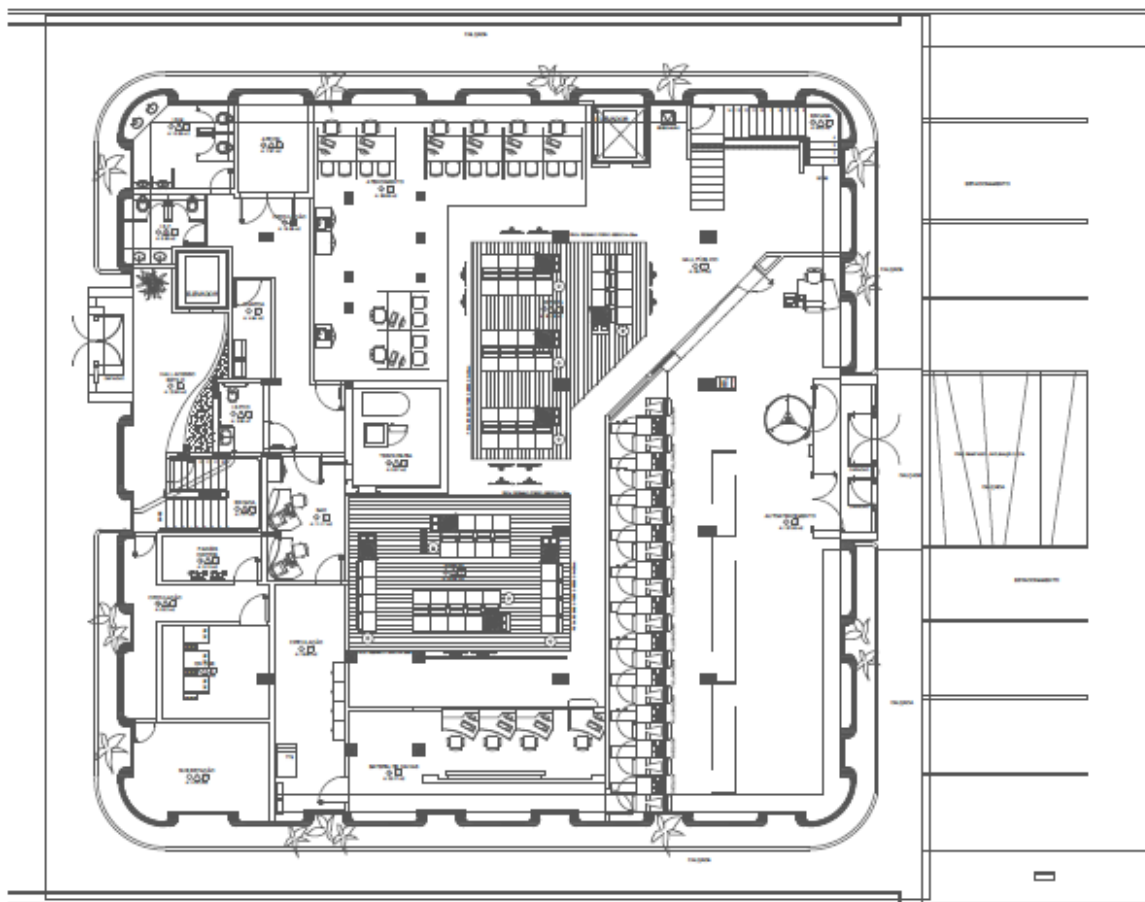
Planta baixa primeiro pavimento (Banco do Brasil, 2014)
